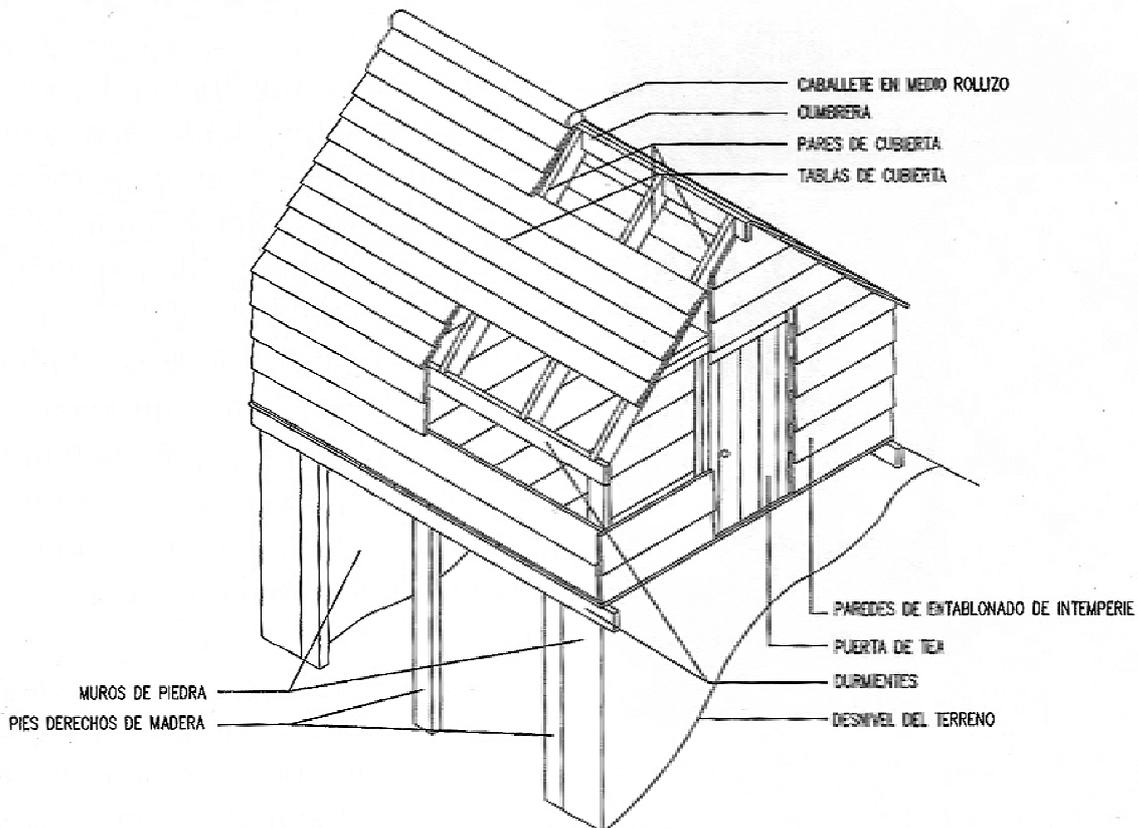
Vivienda de madera que utiliza la planta baja como establo-pajero. (Hernández Delgado 2005)
